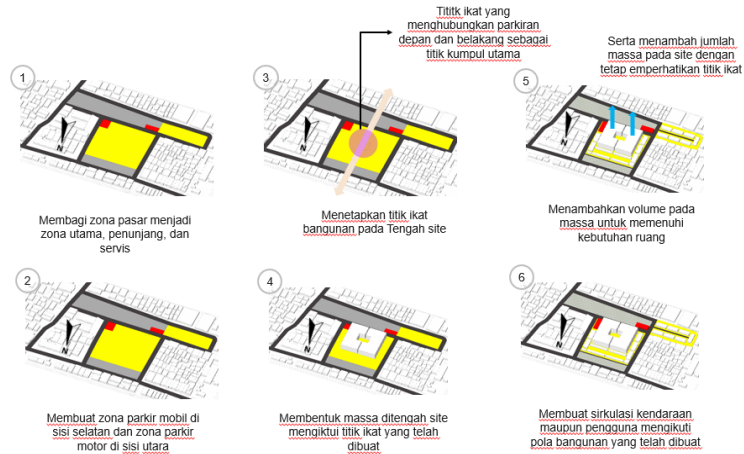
Konsep Bangunan dan Sirkulasi
